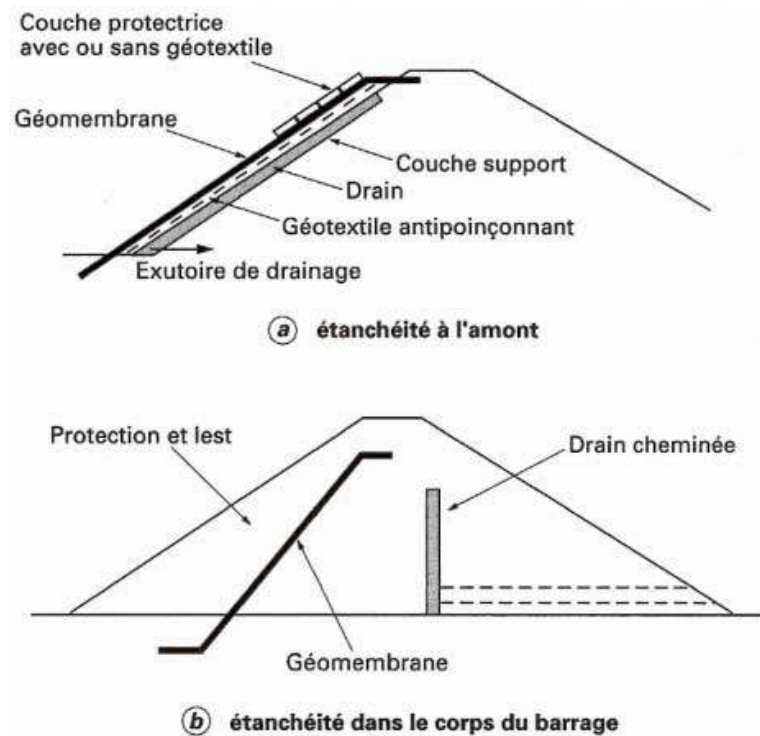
Barrage en terre. Emploi d'une géomembrane
